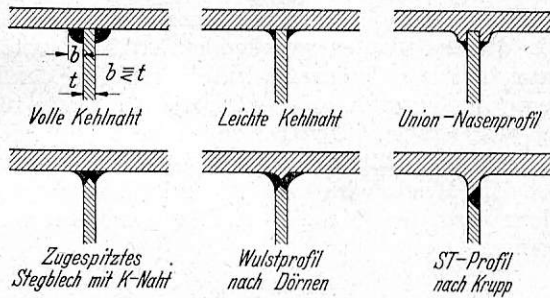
Schweißverbindungen vom Gurt zum Steg.
